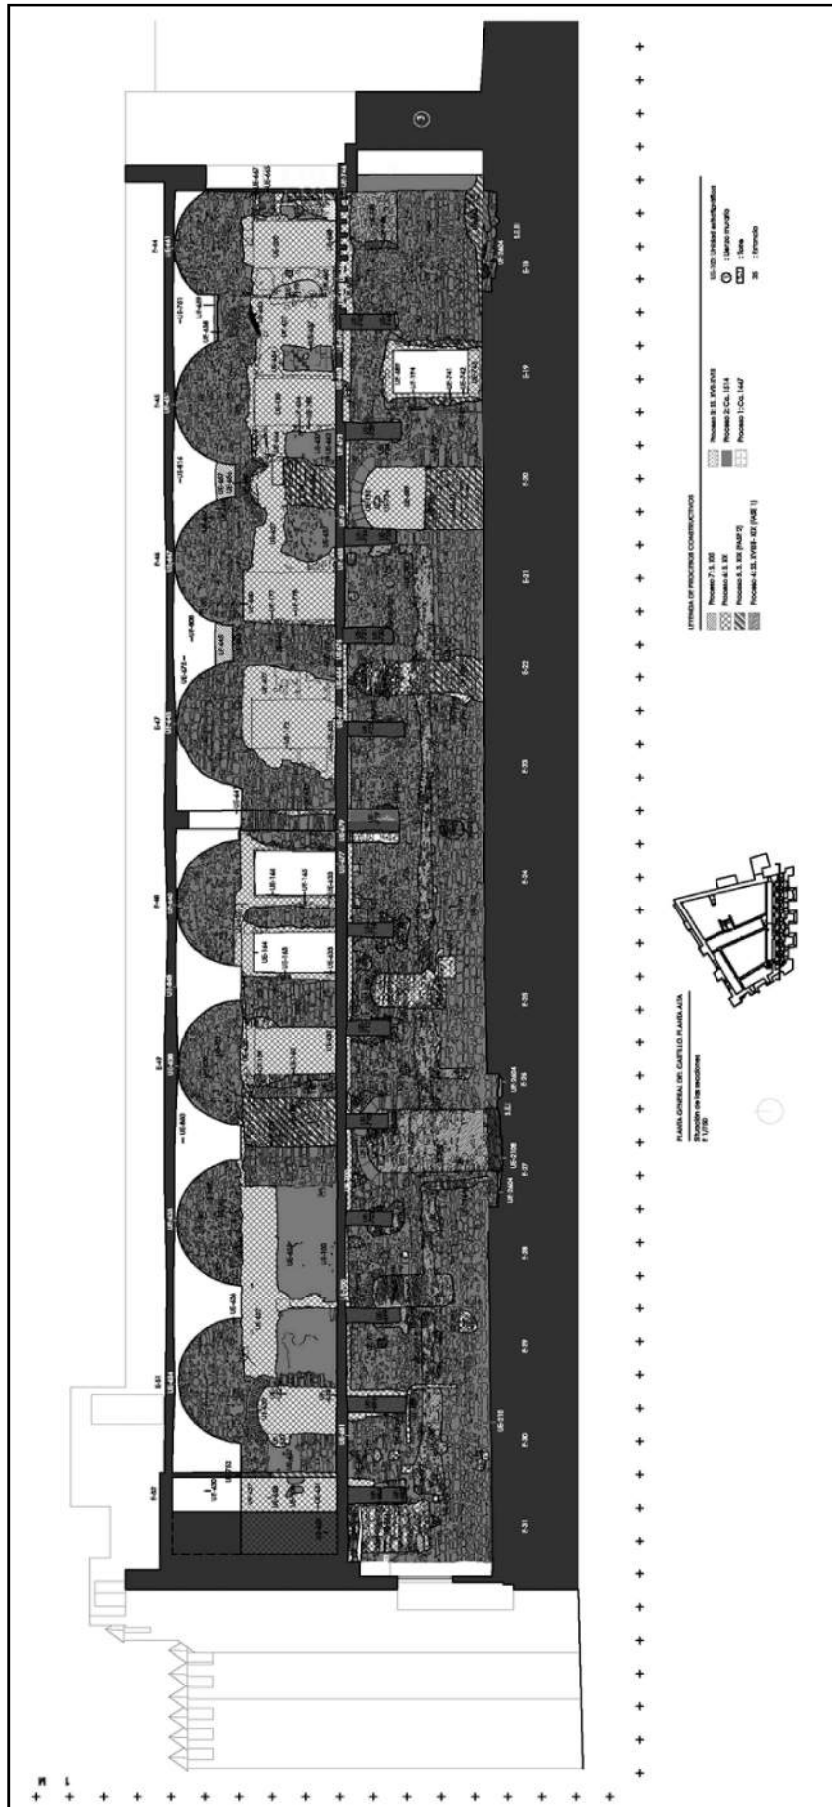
Estudio de alzados del muro septentrional al interior, del pabellón sur. Obsérvese la distribución de las puertas y vanos originales en amarillo.
